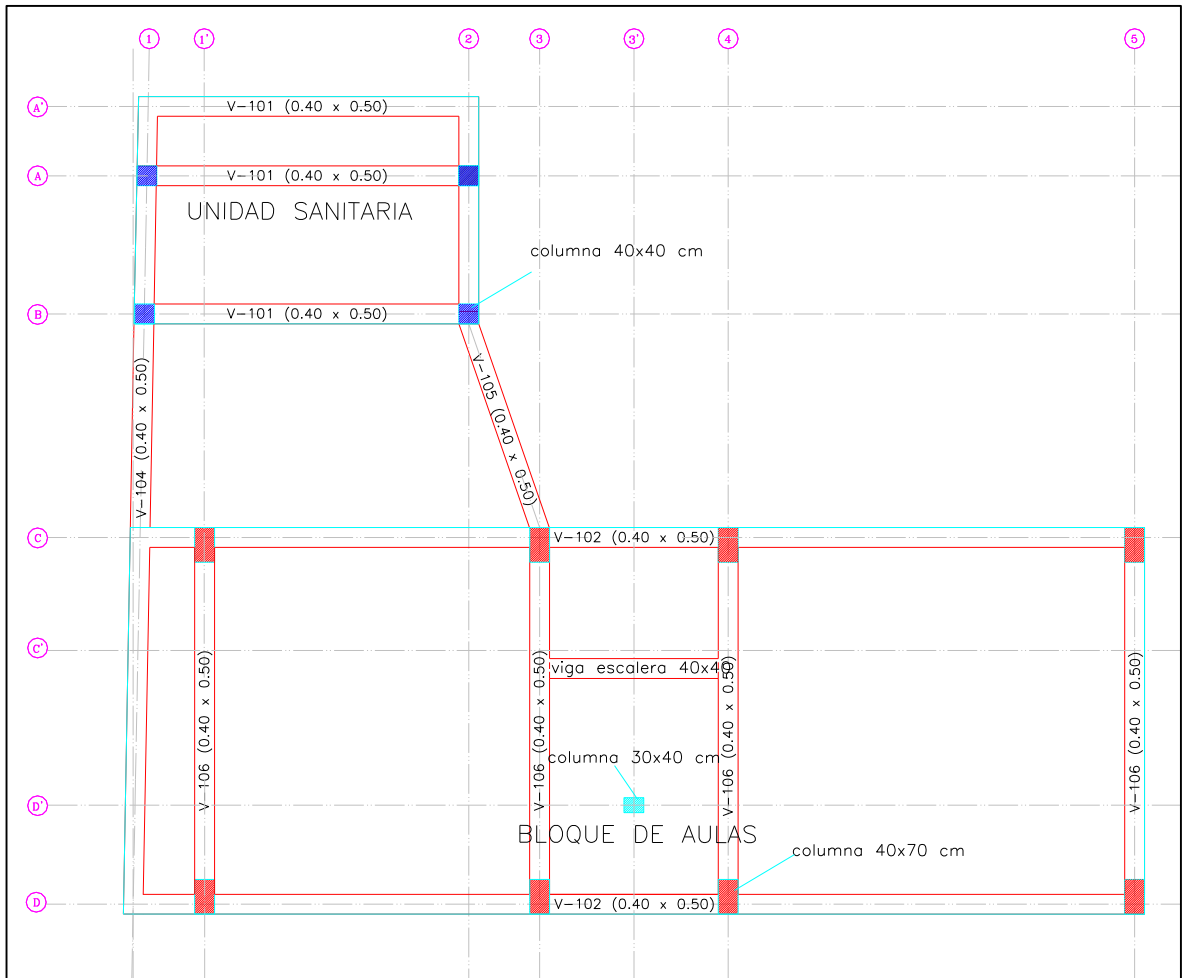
Planta estructura de vigas de amarre de cimentación y columnas primer nivel.
